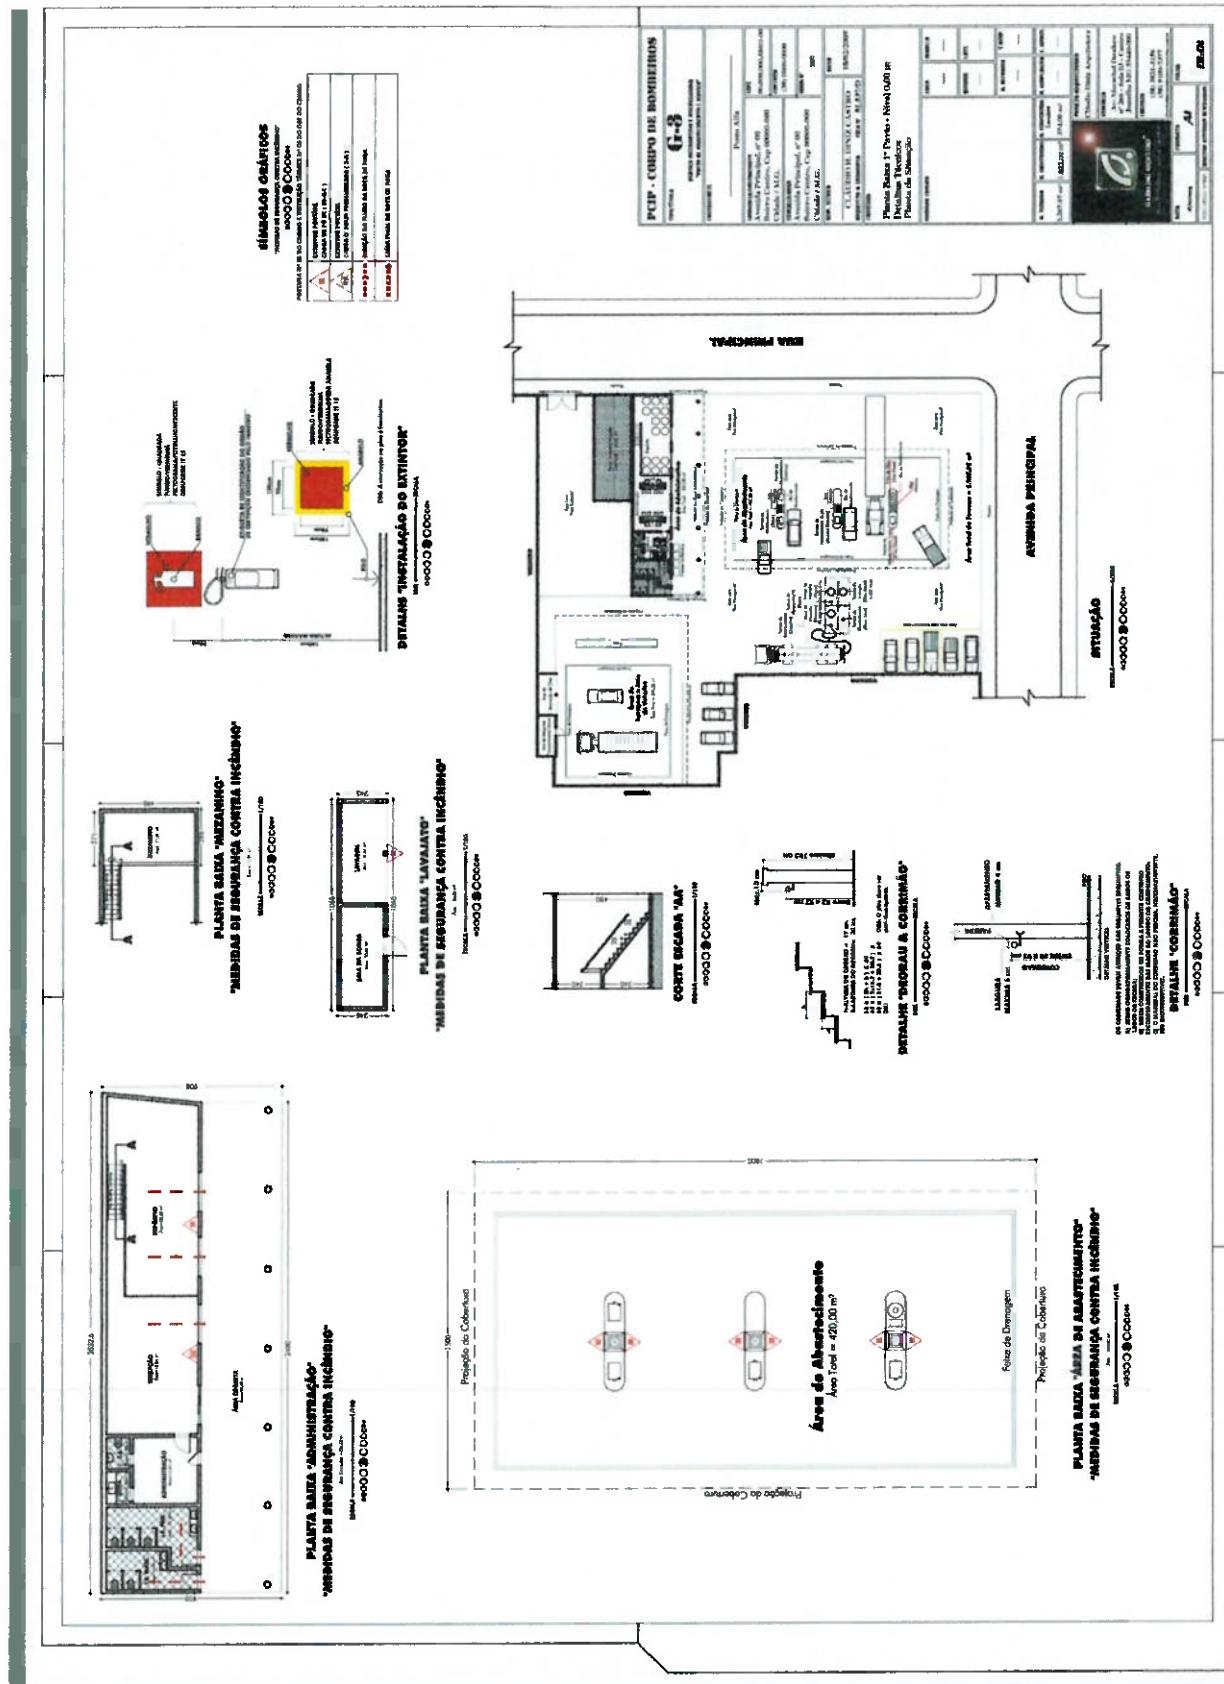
Posto Alfa “Planta de Prevenção de Incêndio”
